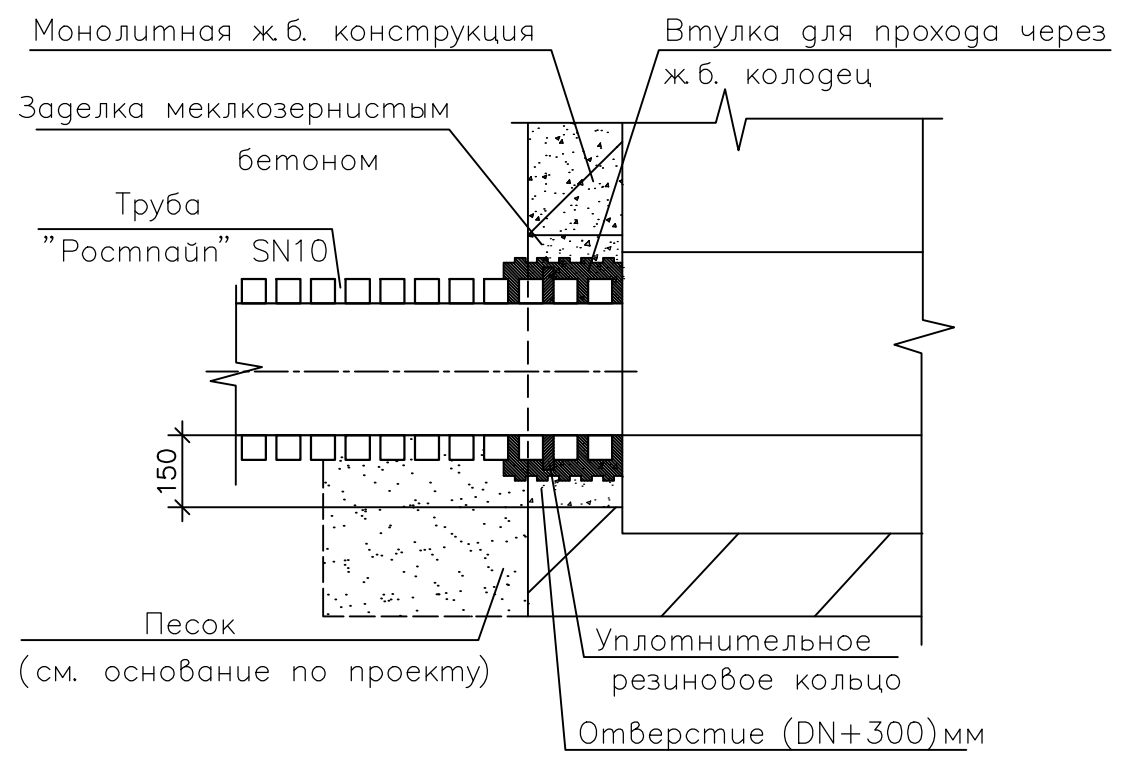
Узлы присоединения трубопроводов из труб "Ростпай" SN10 к колодцам из монолитного железобетона с помощью втулки для прохода через ж/б колодец
